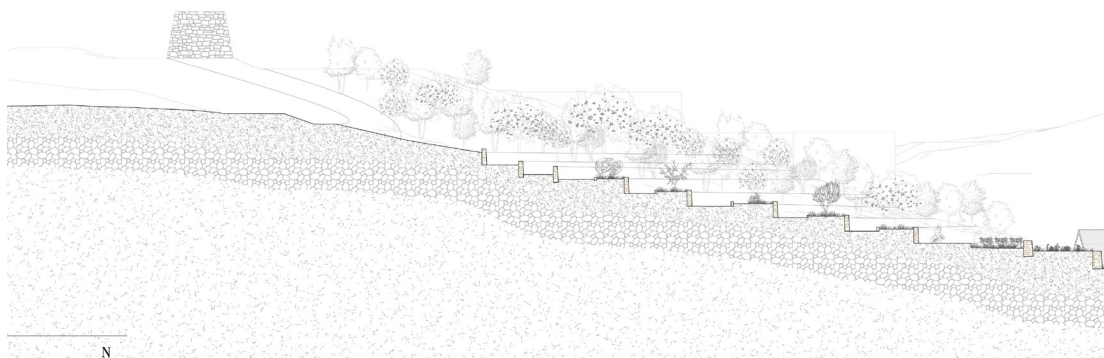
Le long des murets en pierre // Coupe Est-Ouest
